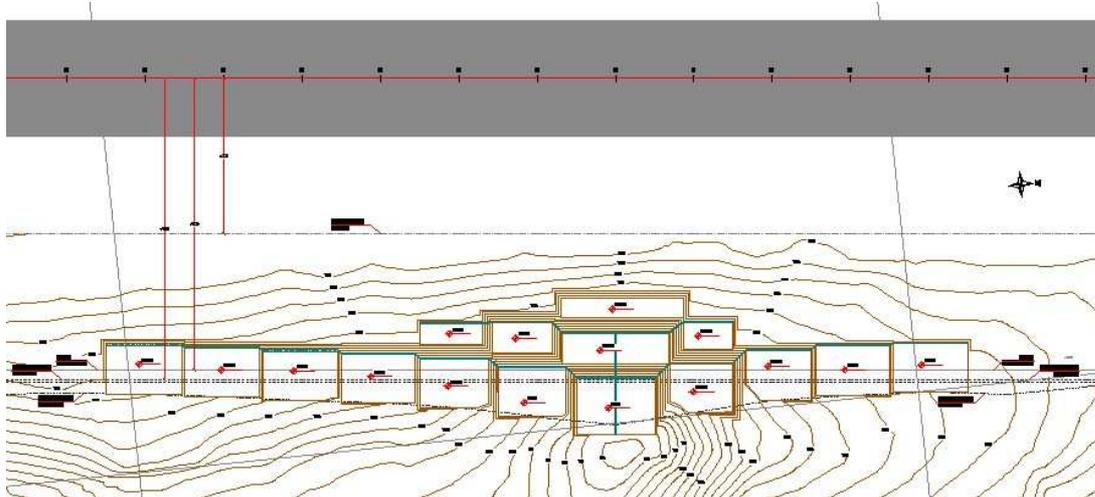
Planta da escavação para implantação do aterro reforçado à direita da faixa de pista, entre as Estacas 21 e 31
